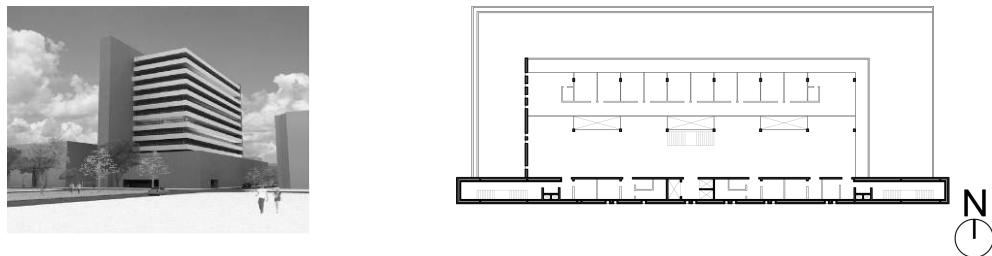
Perspectiva e planta baixa do projeto da Pós-Graduação analisado.
